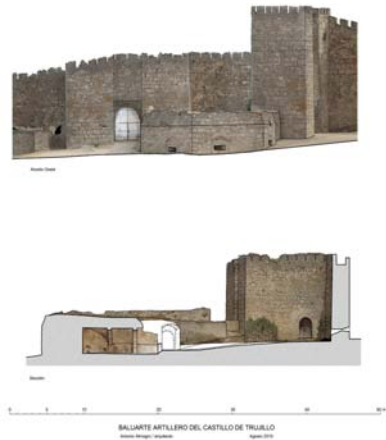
Alzado oeste y sección este-oeste del baluarte.
